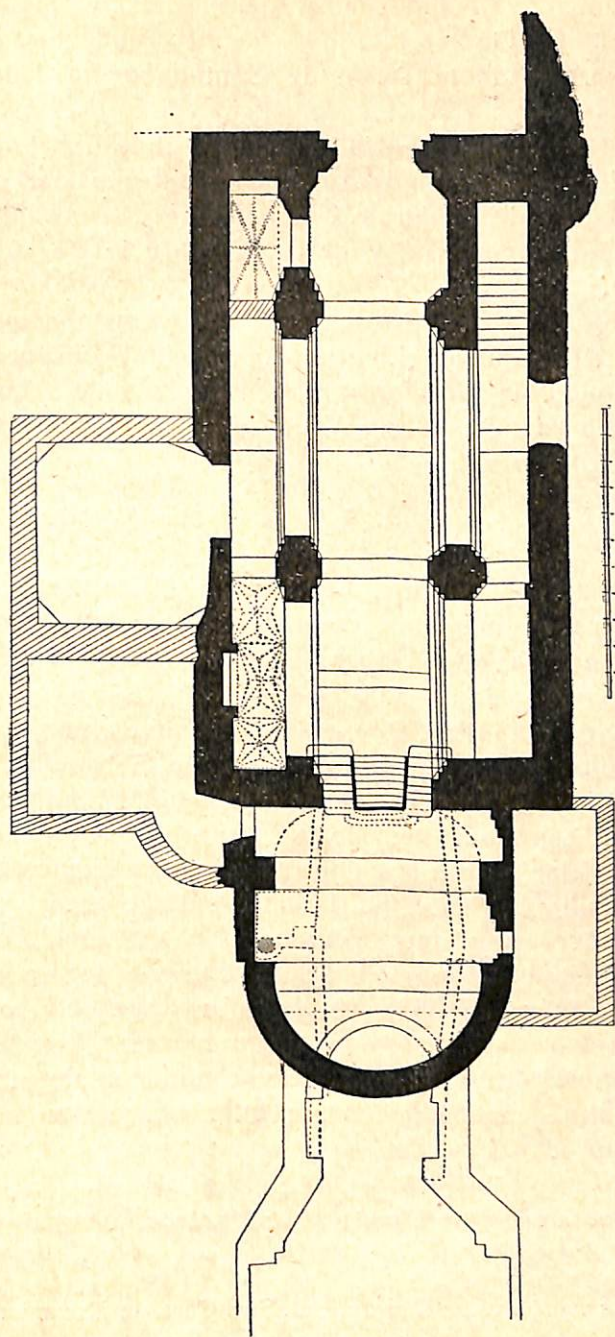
^a y 2.^a—Planta y alzado de San Miguel de Olmedo.
